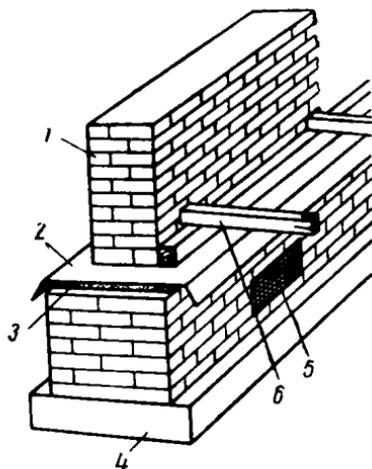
Схема расположения балок пола первого этажа под защитными щитками
